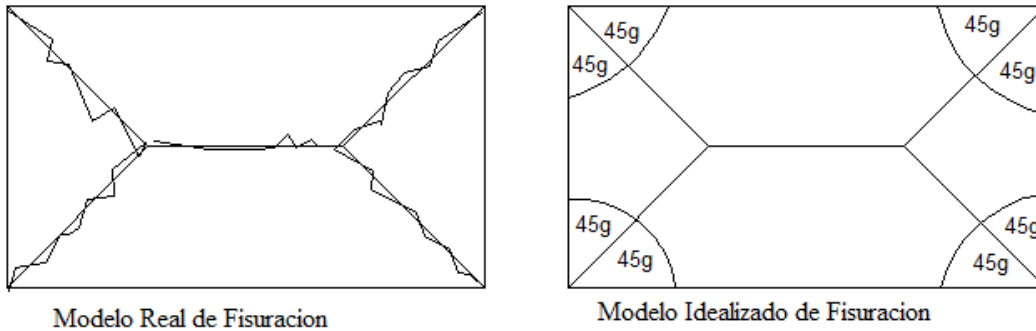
, Líneas de Rotura, Libro Estabilidad de losas aisladas
